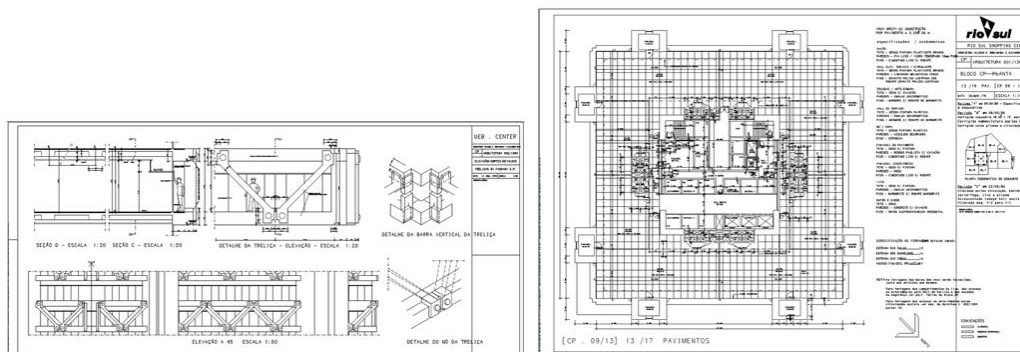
Torre Rio Sul. À esquerda: Detalhes da treliça de fachada. À direita: Planta do 13º/19º Pavimentos, sem treliça na fachada. Fonte: Acervo Rio Sul Shopping Center.
